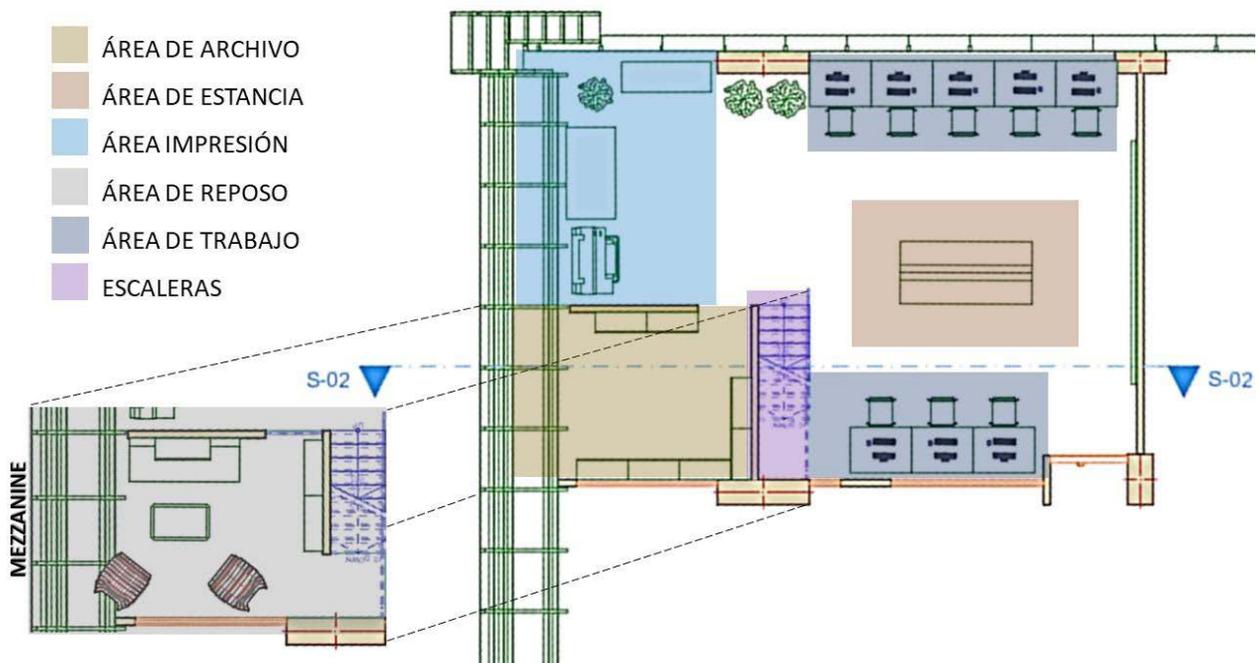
Pérez C. (2020), visualización de propuesta en planta realizado en archicad.
